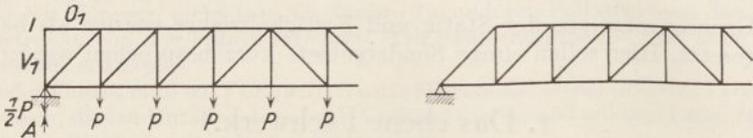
u. b. Parallelträger mit steigenden Schrägstäben.
